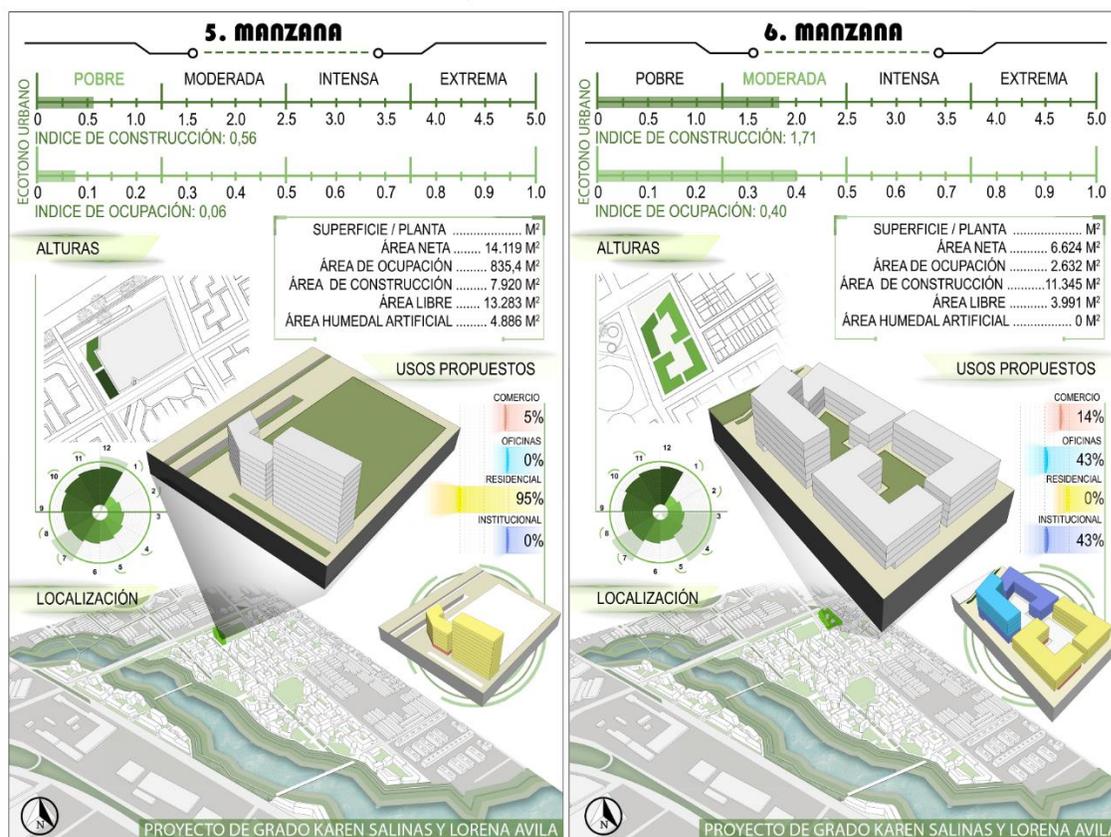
Manzana 5 y 6. Autoría propia (2019)
